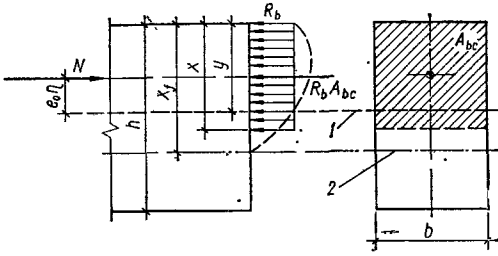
Схема внутренних усилий в сечении внецентренно-сжатого бетонного элемента, рассчитываемого без учета сопротивления бетона растянутой зоны:
